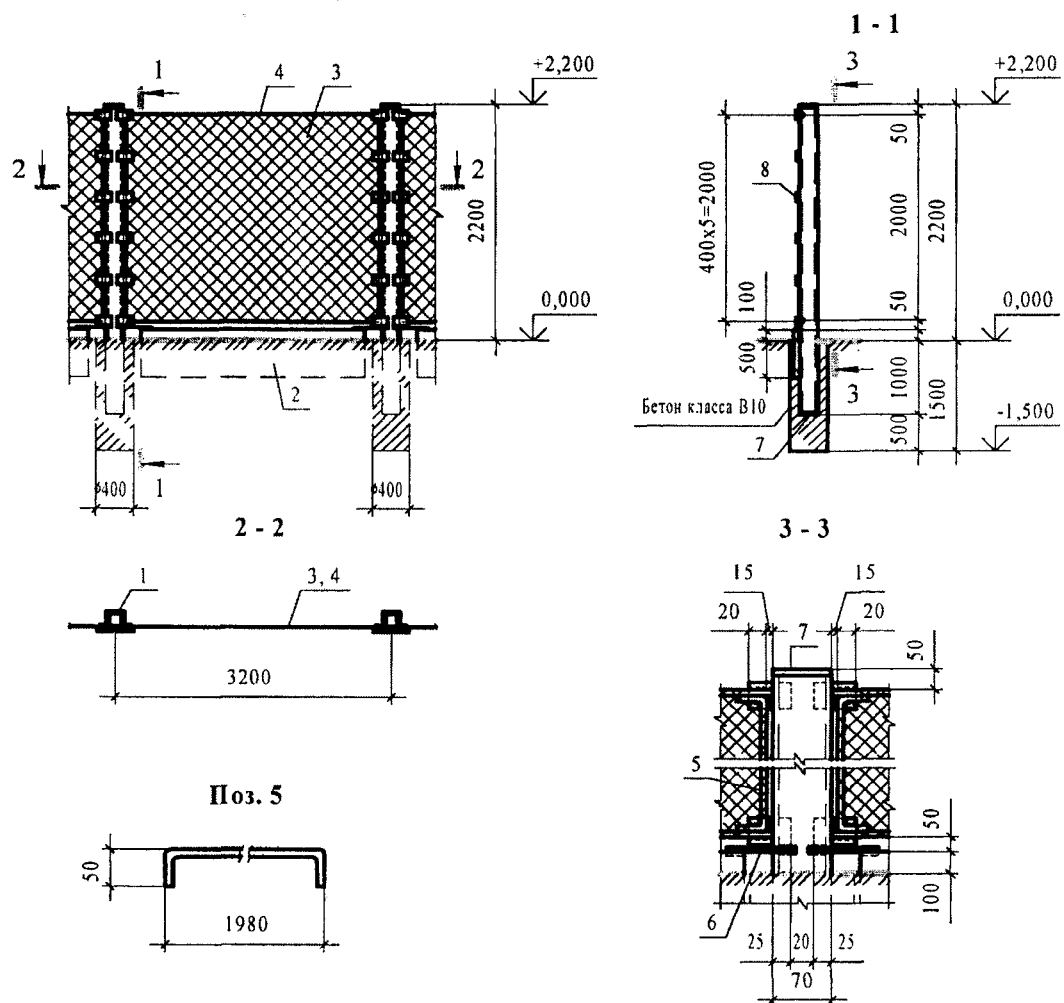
Ограждение из металлической сетки высотой 2,2 м с подземным усилением на железобетонных стойках
